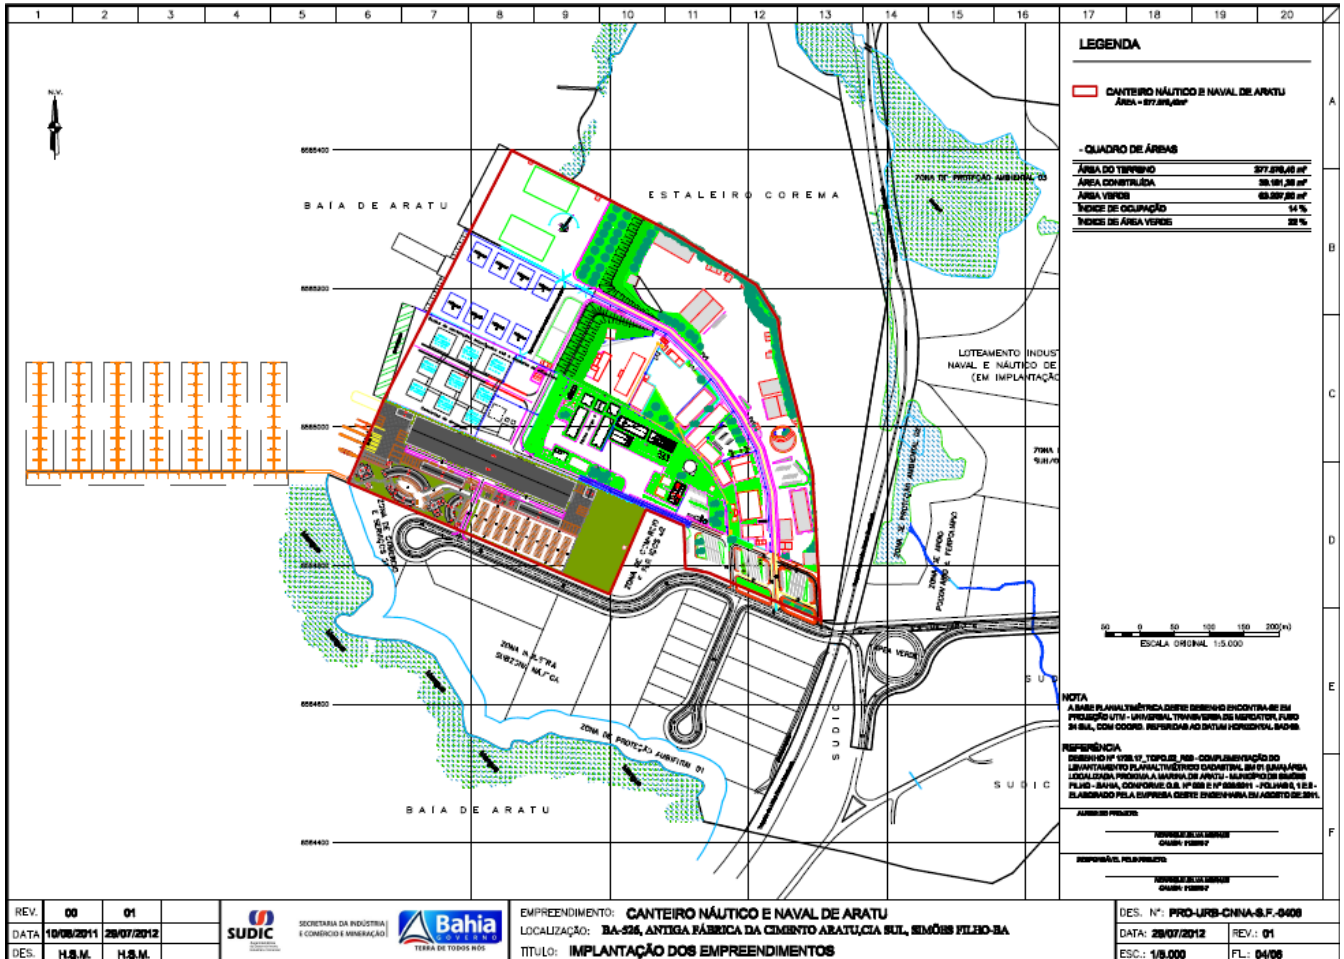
Planta de implantação dos módulos e marina (Anexo 2.3)
